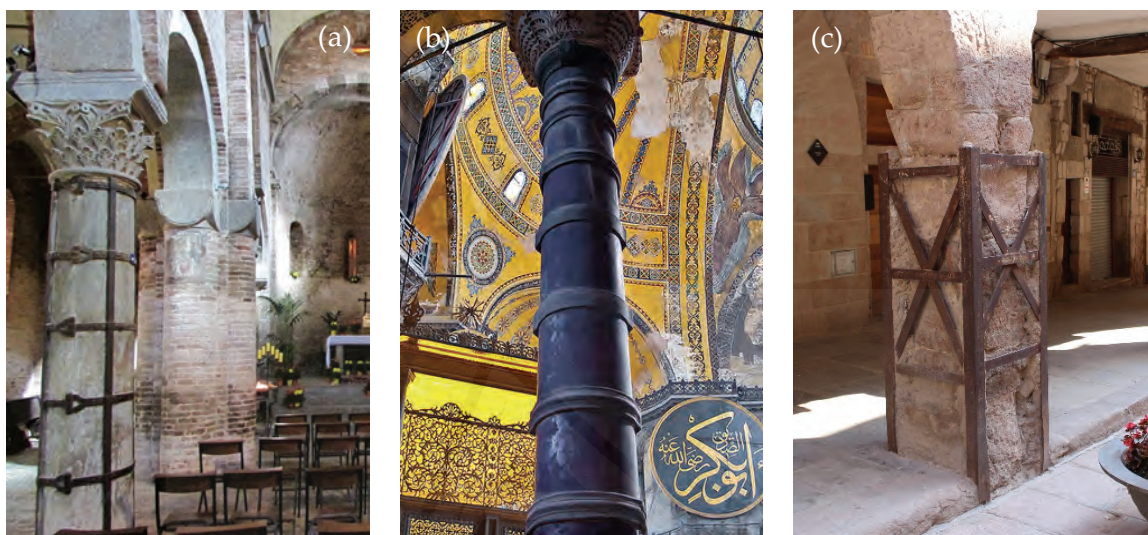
Refuerzo de columnas de piedra mediante zunchado con elementos de acero.
